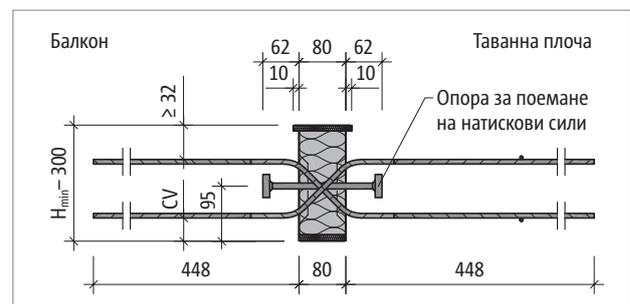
Schöck Isokorb® T тип QP-V7: Сечение на продукта
